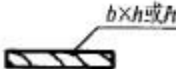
非焊接节点板尺寸的标注方法
